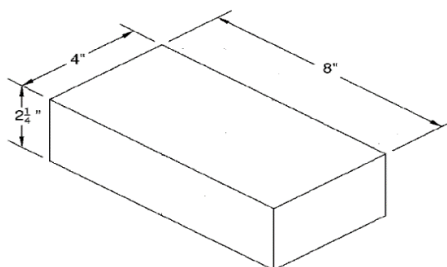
Dimensiones de muestra de prueba C 99/C 99M – 09.
